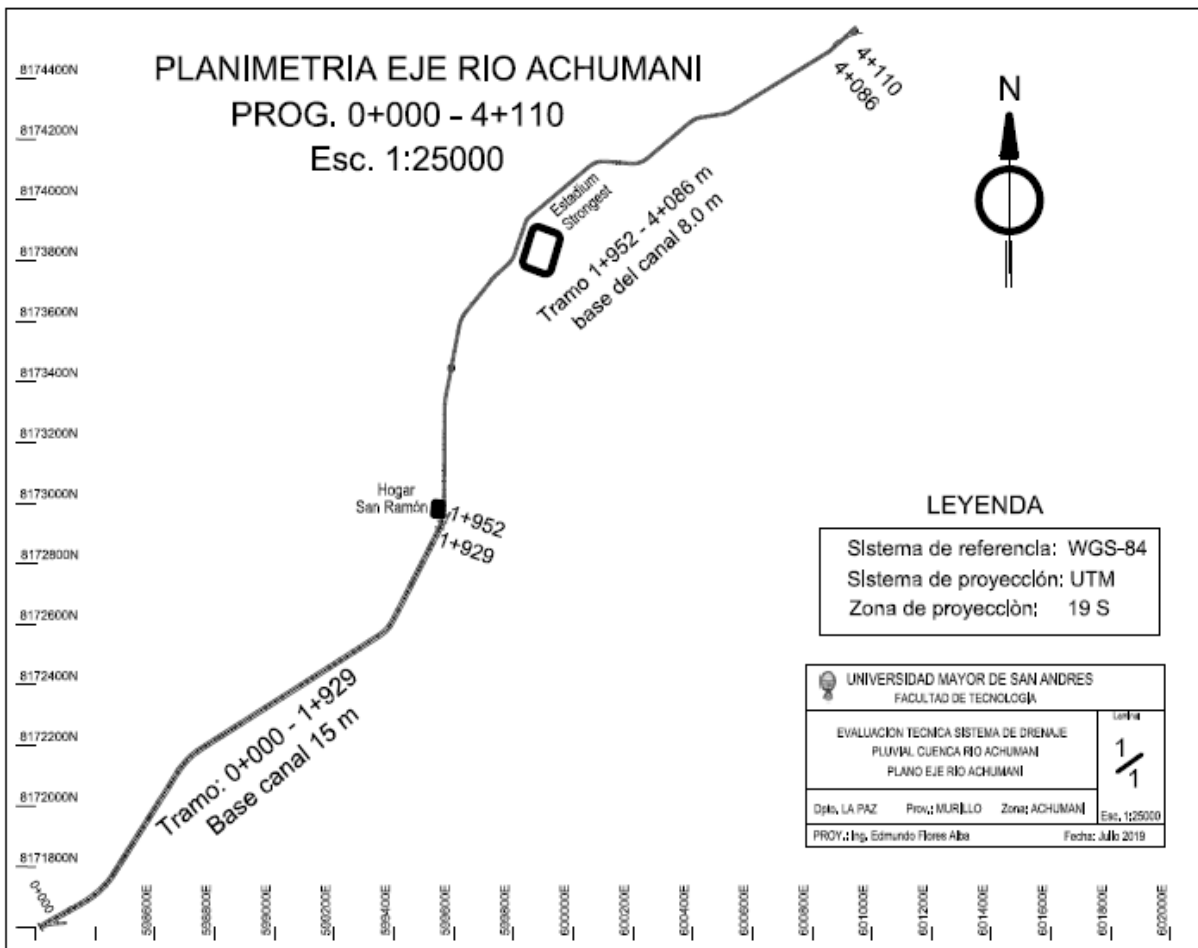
Planimetría eje canal de Achumani (Elaboración propia)
